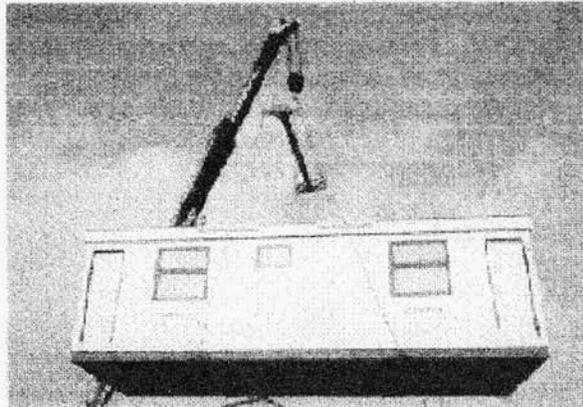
Vivienda SABINCO prefabricada en faena de transporte.
